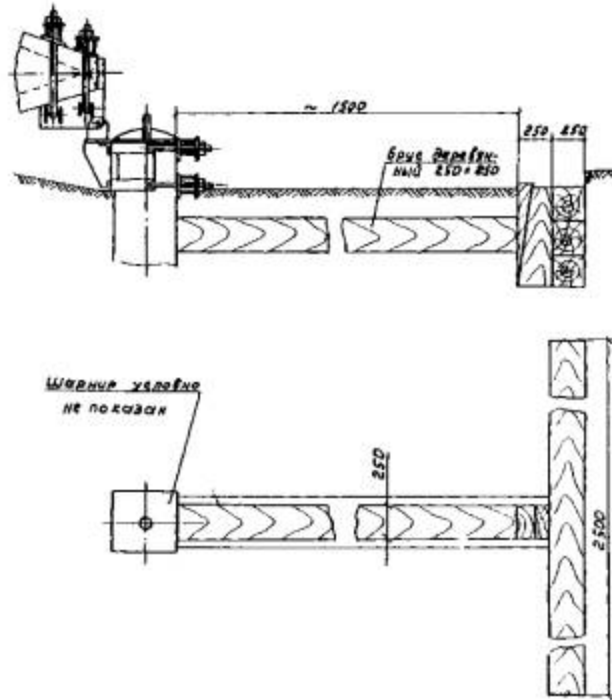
Узел раскрепления фундамента от сдвига при установке опор типа ПП 750
